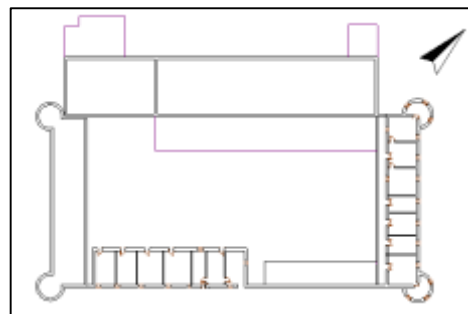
Plan étage de la demeure/ Source : Auteur, 2025
